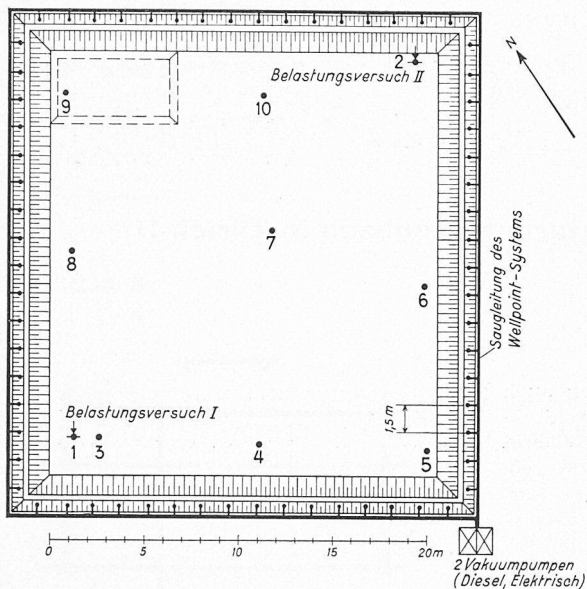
Plan 1:400 der Sondierungen und Belastungsversuche, Schema des Wellpoint-Systems
